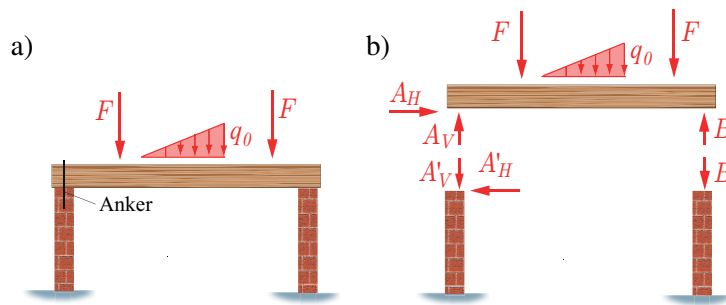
Dachbinder auf Mauerwerk: a) System mit Belastung, b) Lagerreaktionen im Freikörperbild
